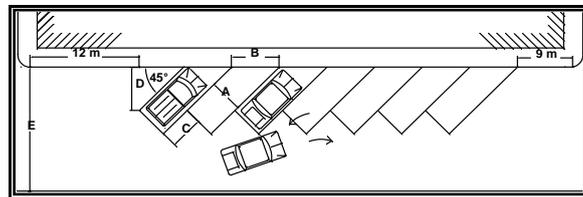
Modul Parkir di Jalan dan Taman Parkir
